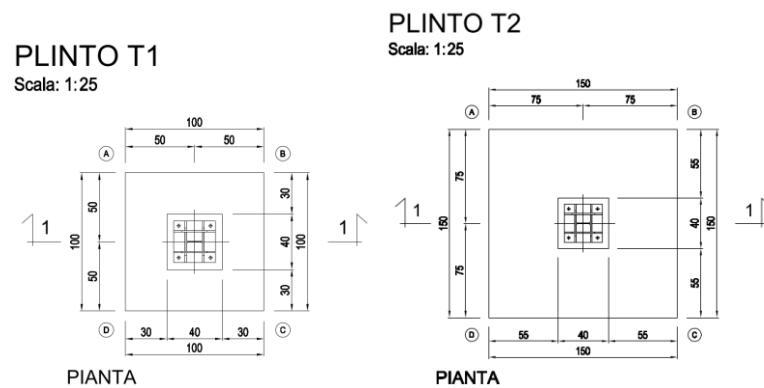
Geometria della fondazione – PLINTI T1 e T2
